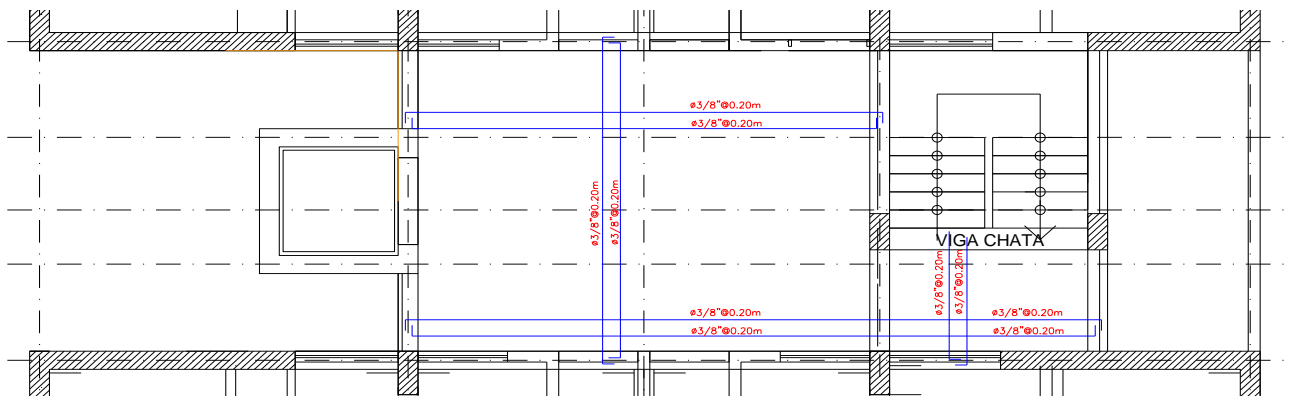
Acero de refuerzo en losa maciza ubicada en el Halls
